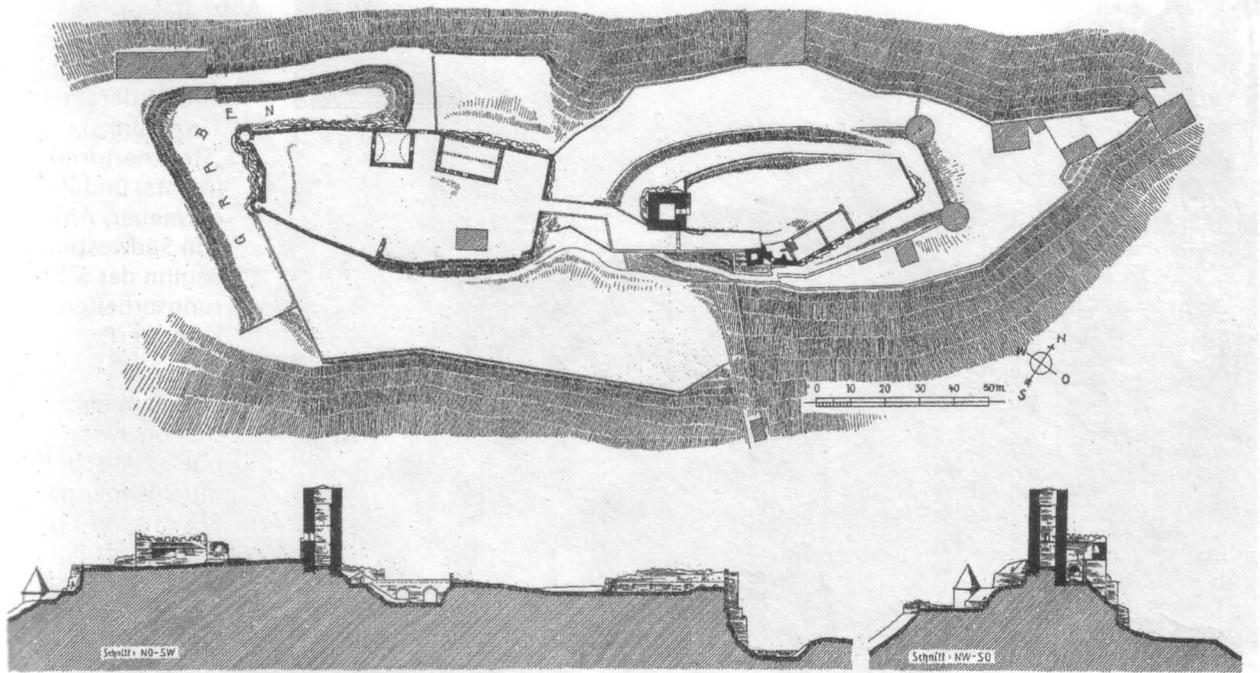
Pappenheim. Grundriß der Burganlage und Schnitte. (Aus: KDM Weissenburg, S. 365)
